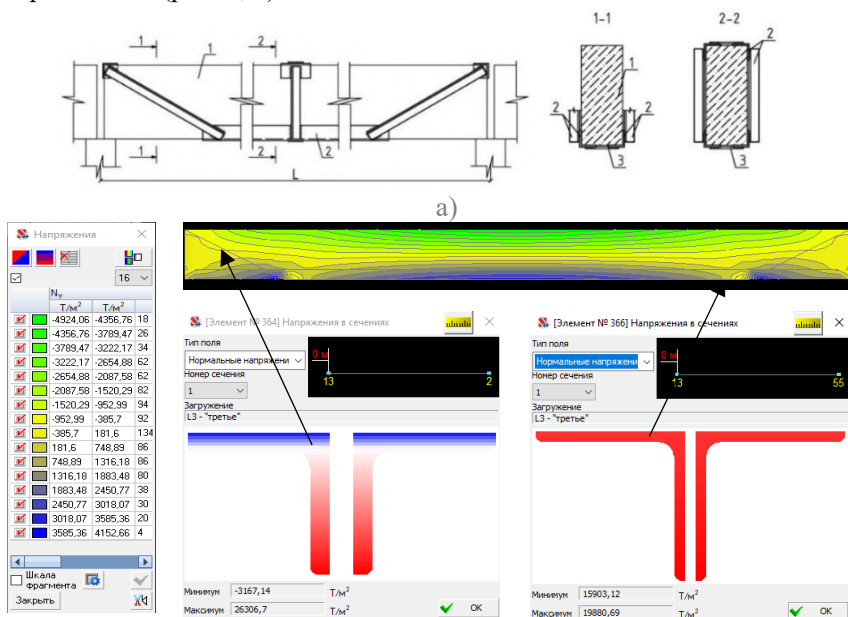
Схема железобетонной балки, рассматриваемая при оптимизации (а): 1 - балка; 2 – стальные пролетные и наклонные уголки; 3 – соединительные планки (пластинки); НДС варианта конструкции (б)
